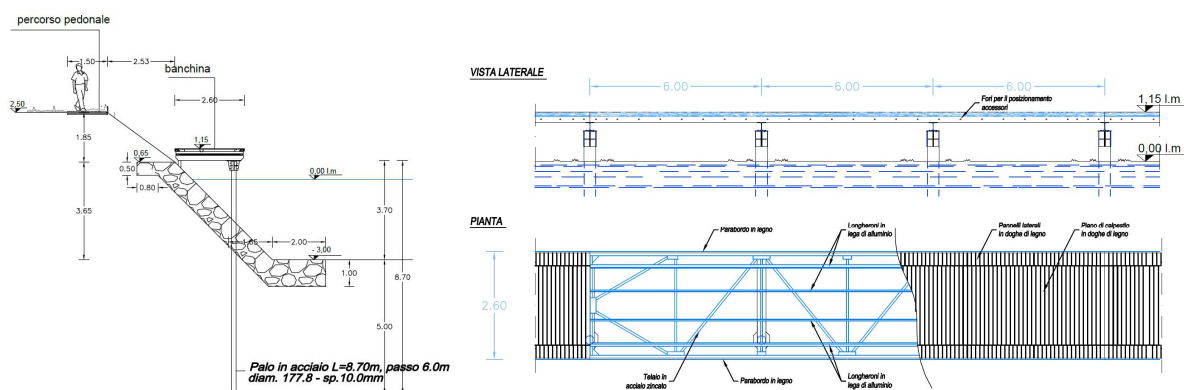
Sezione, pianta e vista laterale delle banchine pedonali
